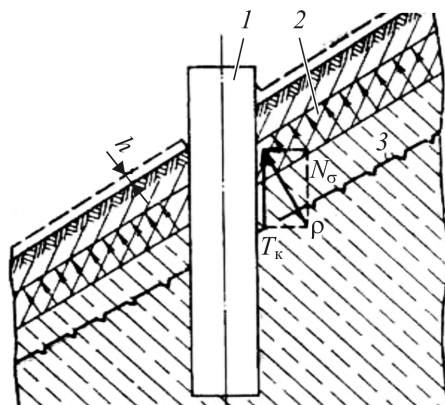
Схема воздействия сил пучения на одиночный фундамент, установленный в грунте с наклонной поверхностью [6]: 1 – фундамент; 2 – слой сезонного промерзания; 3 – поверхность вечномёрзлого грунта
